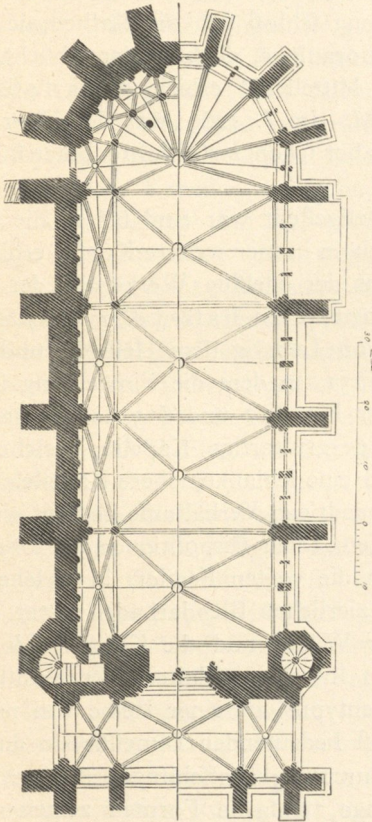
Ste. Chapelle zu Paris. Grundriß.
